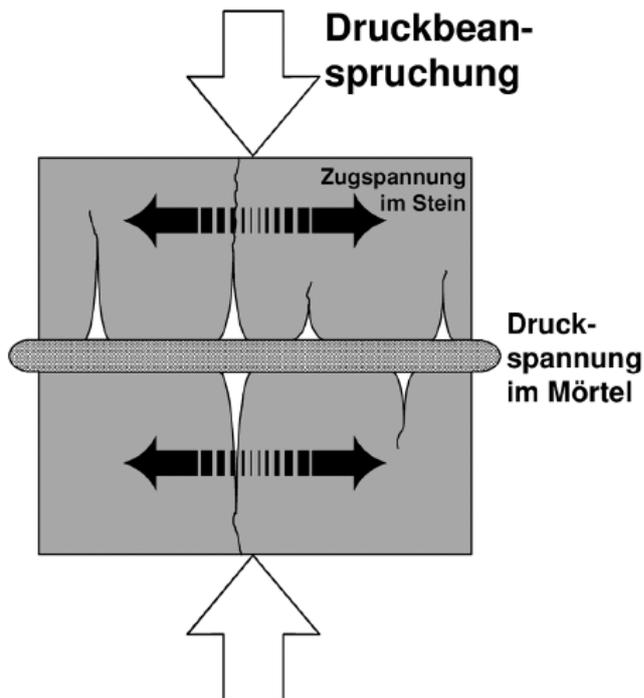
Mauerwerk unter Druckbeanspruchung [27]
